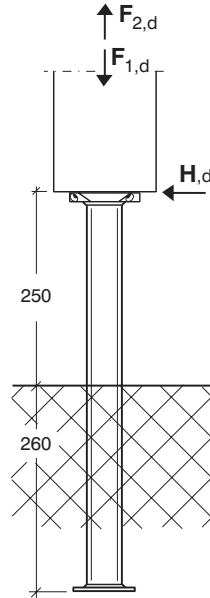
und 4: Typ PL: Druck, Zug, horizontale Belastung
